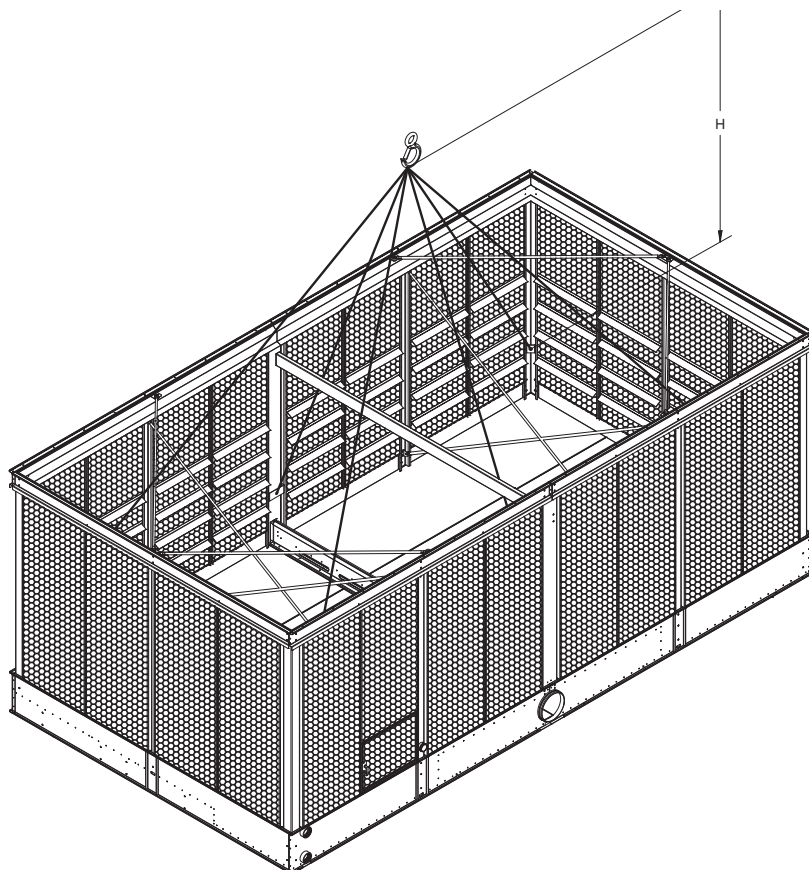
Sezione inferiore larga 14' (4,3 m)
